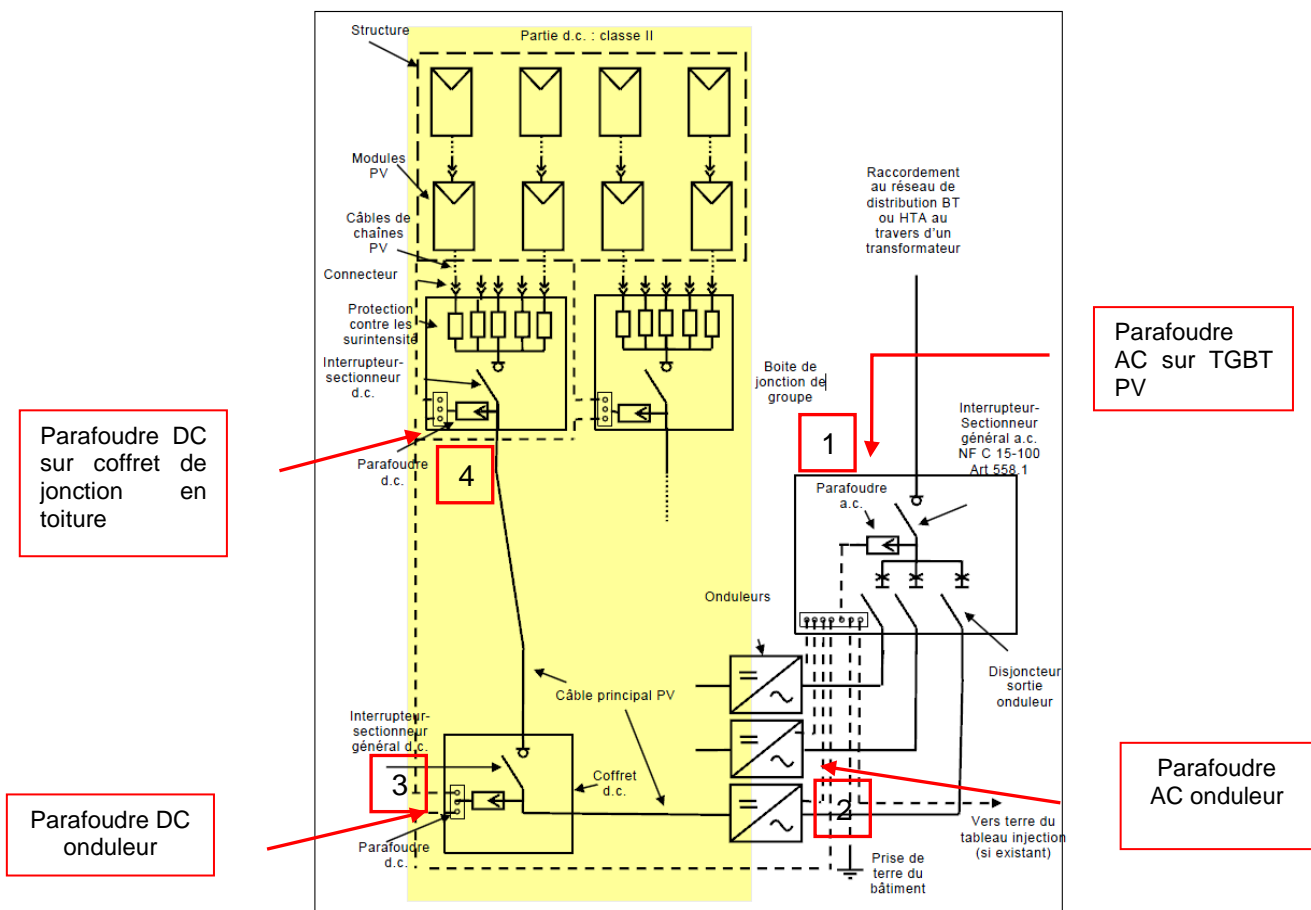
Implantation des parafoudres sur l'installation PV. (UTE 15-712)
